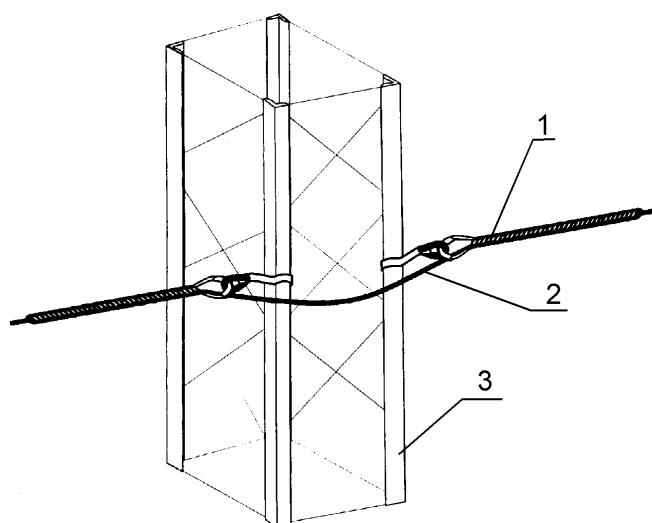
Кріплення ОК на проміжній металевій опорі (1 – затискач натяжний; 2 – ОК; 3 – опора металева)
